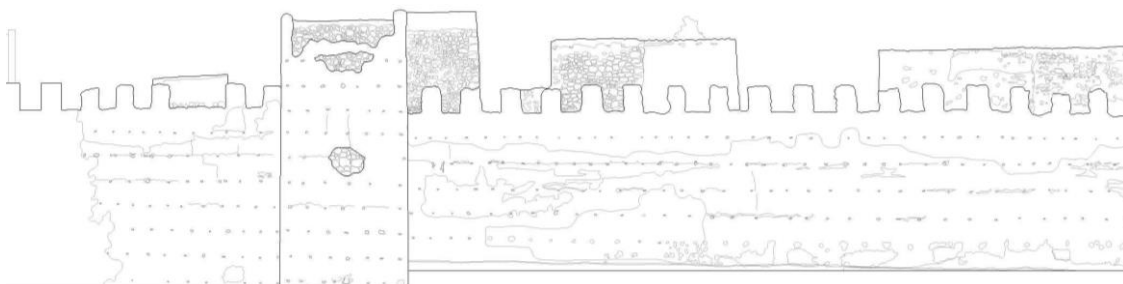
Alzado Norte TC y L3. Escala 1/200. Fuente: Autora.
